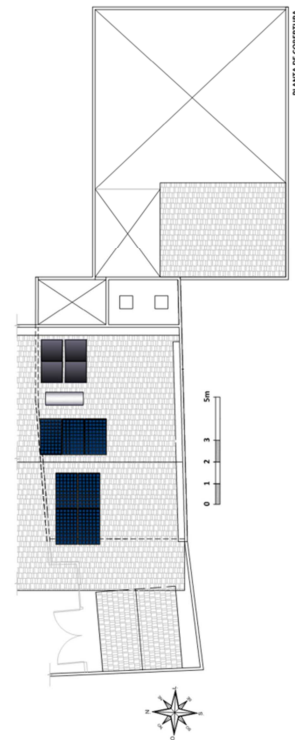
Planta de cobertura com localização dos painéis solares (Fonte: Larissa Anibal).
